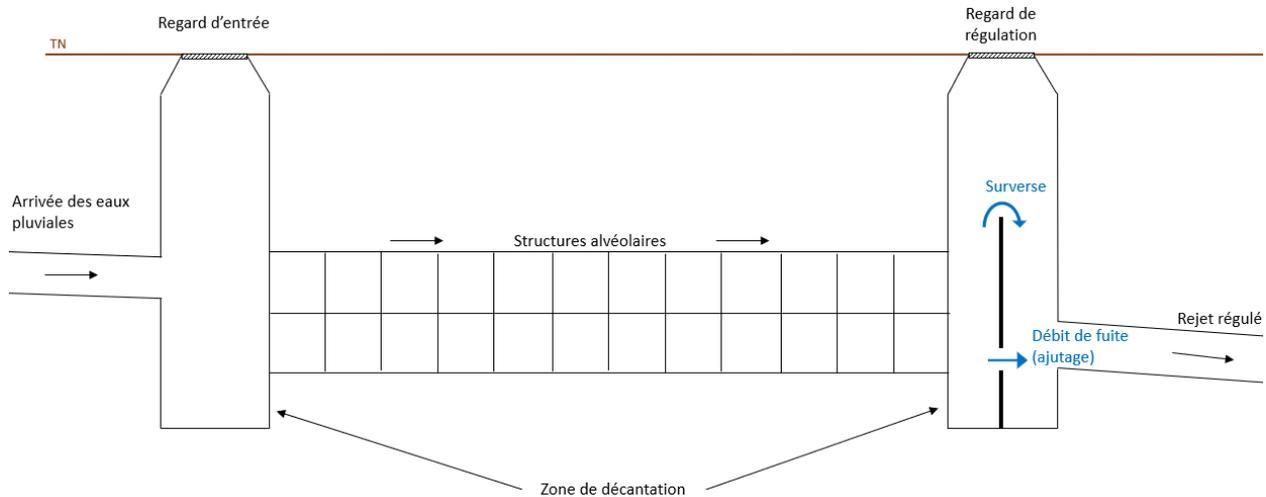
Schéma de principe d'un stockage en structures alvéolaires sous chaussée (ECR Environnement)
